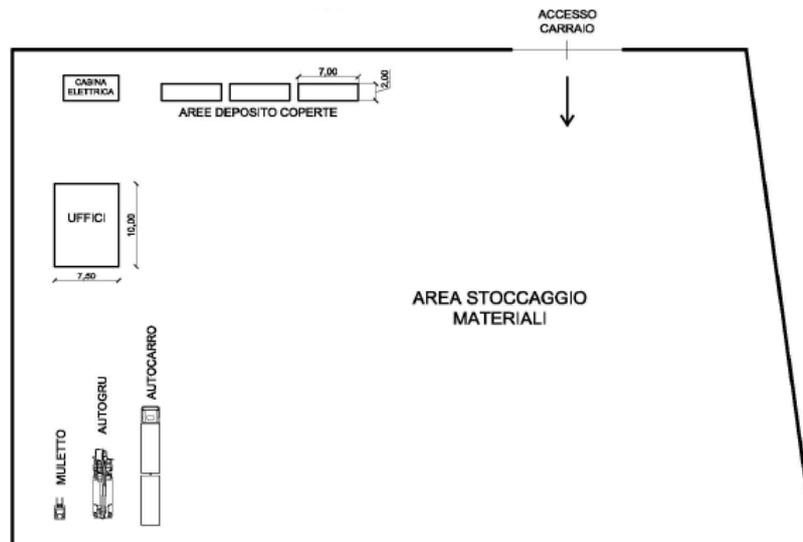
Tipologico del layout dell'area centrale di cantiere
